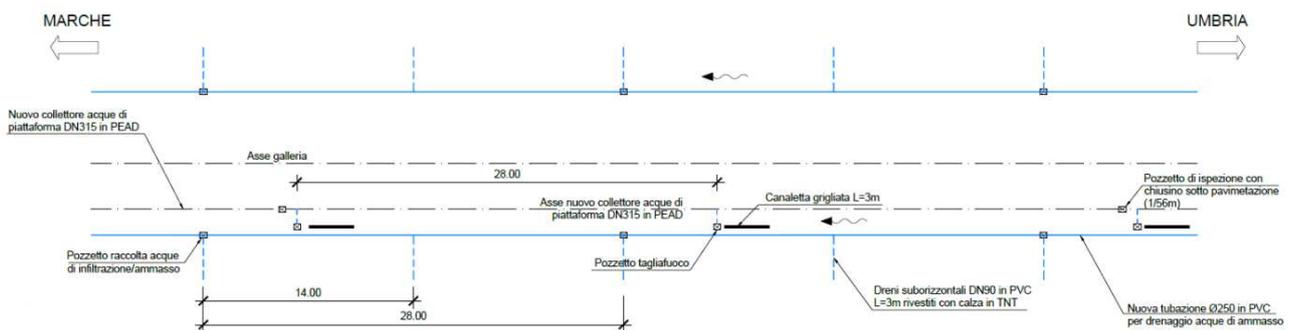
Galleria Guinza - Sistemazione idraulica – Rappresentazione schematica
